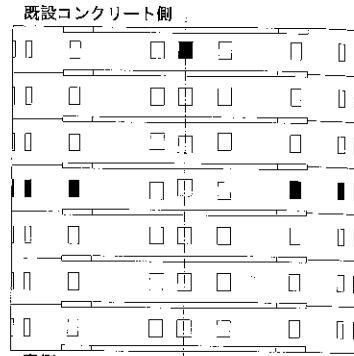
コンクリート打込み口の配置例(中流動覆工コンクリートの場合)
